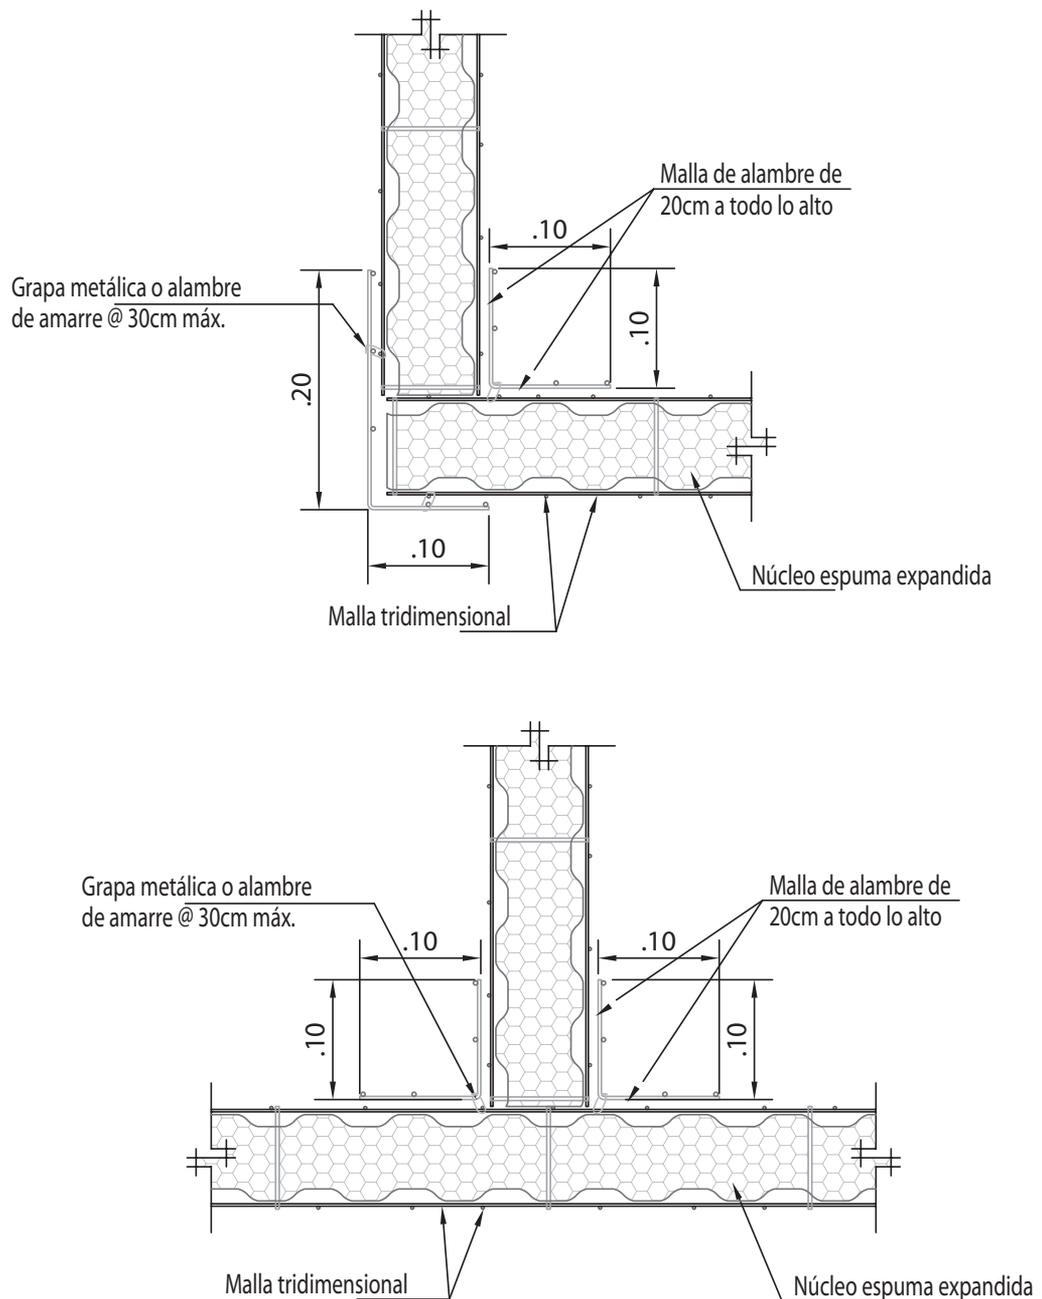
Detalle intersecciones en pared tipo emparedado.
